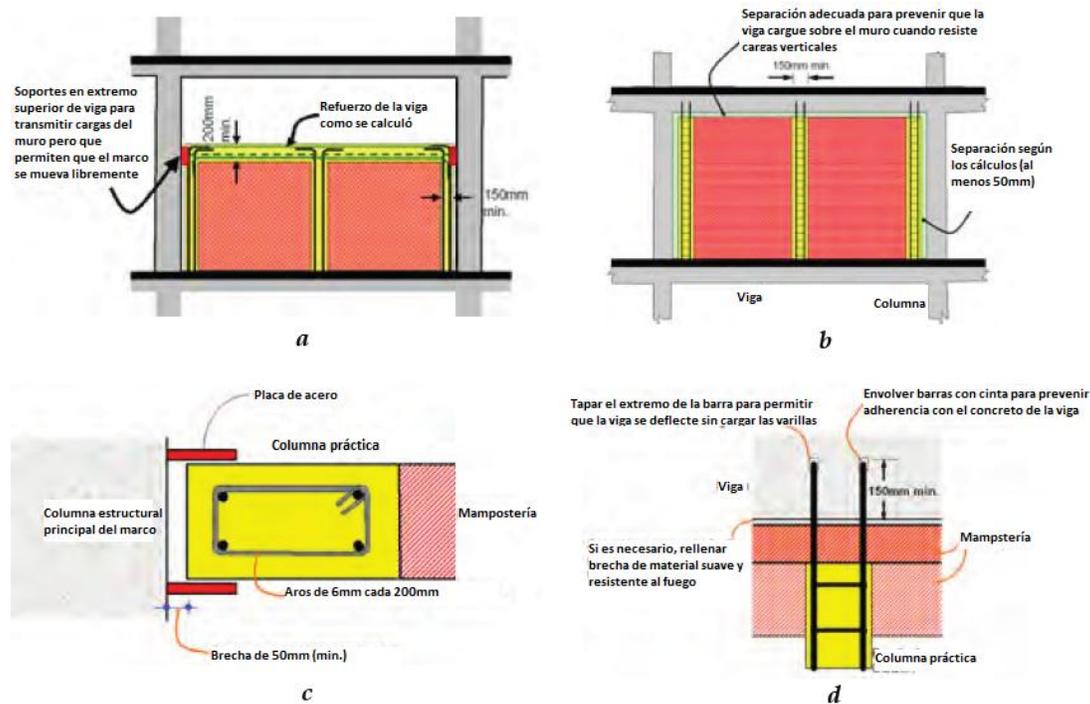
Las columnas prácticas para aislar los muros de mampostería de relleno en Indonesia: (a) relleno de altura parcial, (b) relleno de altura completa, (c) acercamiento de los detalles de una columna práctica, y (d) acercamiento de los detalles del anclaje de las columnas prácticas dentro de la viga superior, pero sin ofrecer resistencia a la deformación lateral del marco del edificio (fuente: Murty et al.)
